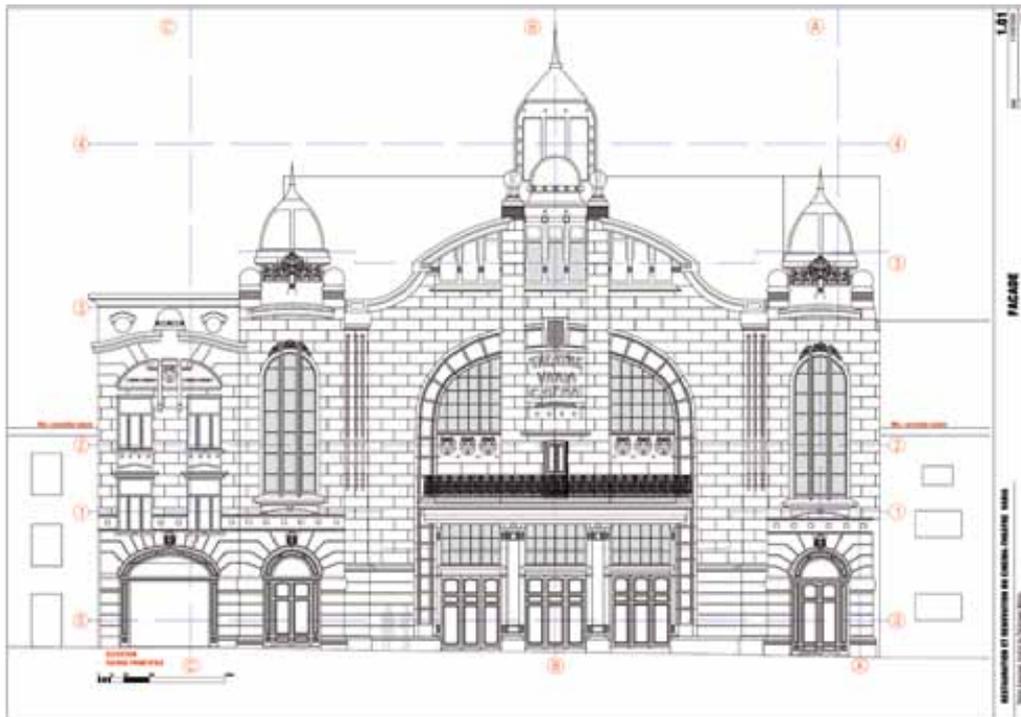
Plan d'ensemble de restauration de la façade classée⁸
